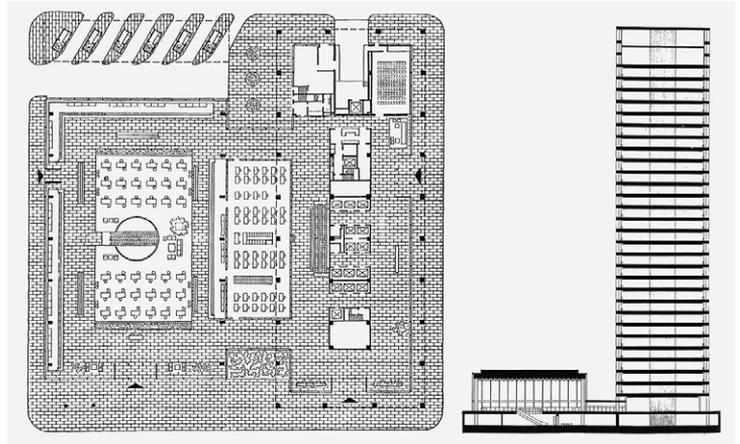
Skidmore, Owings & Merrill: First City National Bank, Houston 1961, Grundriss und Schnitt
